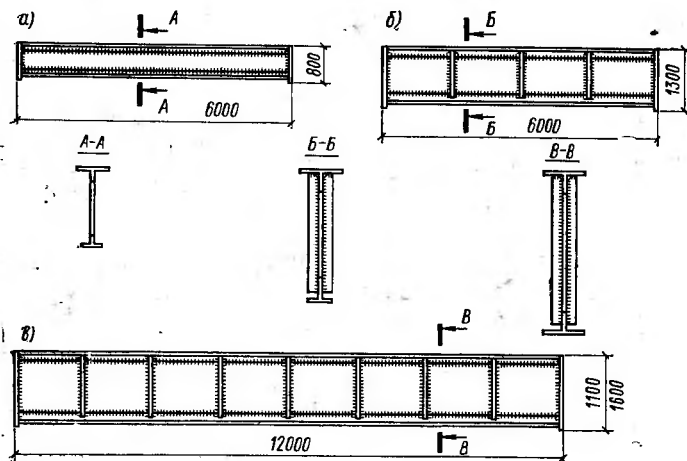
Типовые разрезные подкрановые балки с поясами из тавров
